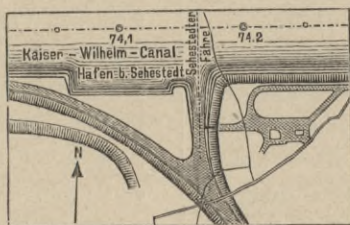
Lageplan des Lösch- und Ladeplatzes bei Sehestedt. 1:6000.
